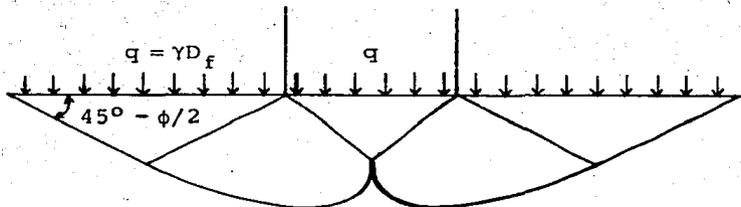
MECANISMO DE FALLA SEGUN TERZAGHI.
